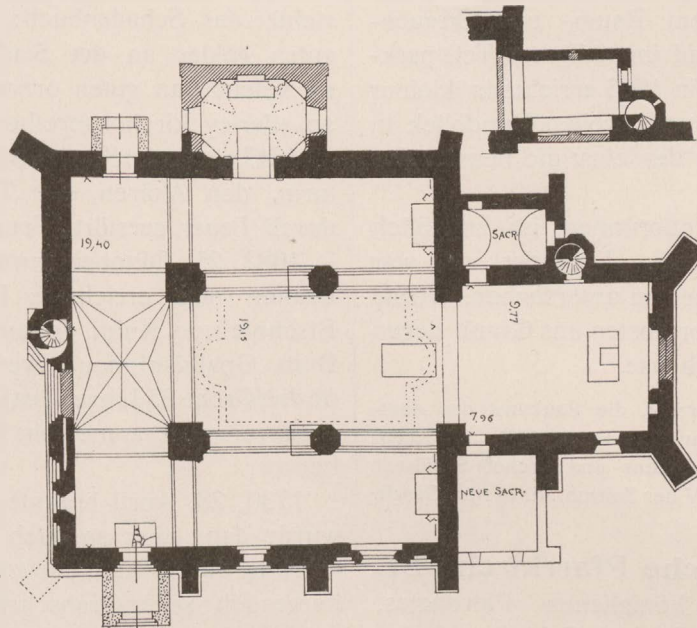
Kath. Pfarrkirche zu Christburg. Erdgeschoß Grundriß; oben rechts alte Empore über der Sakristei.
